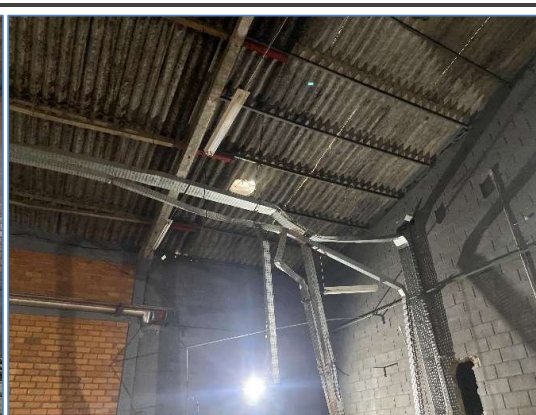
vista interna do galpão/barracão, mau estado de conservação, telhas trincadas, infiltrações.
